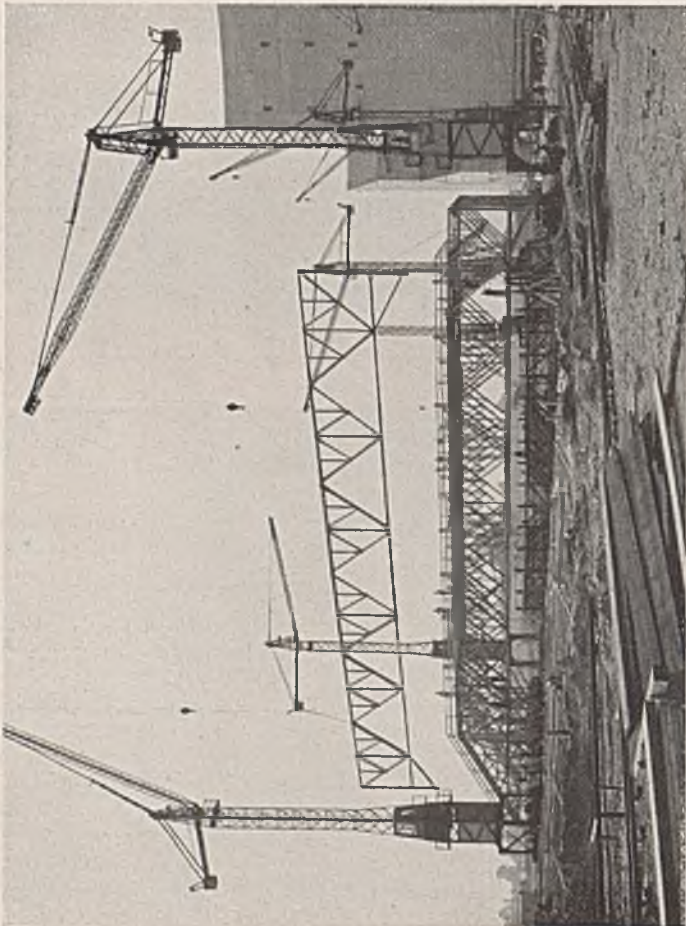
Zusammenbau der hölzernen Betonierbrücken.
